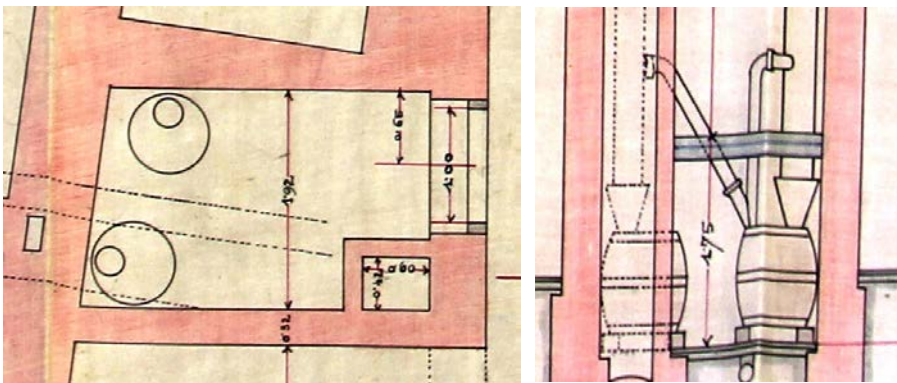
Fassapparat in Grundriss und Schnitt<sup>79</sup>
